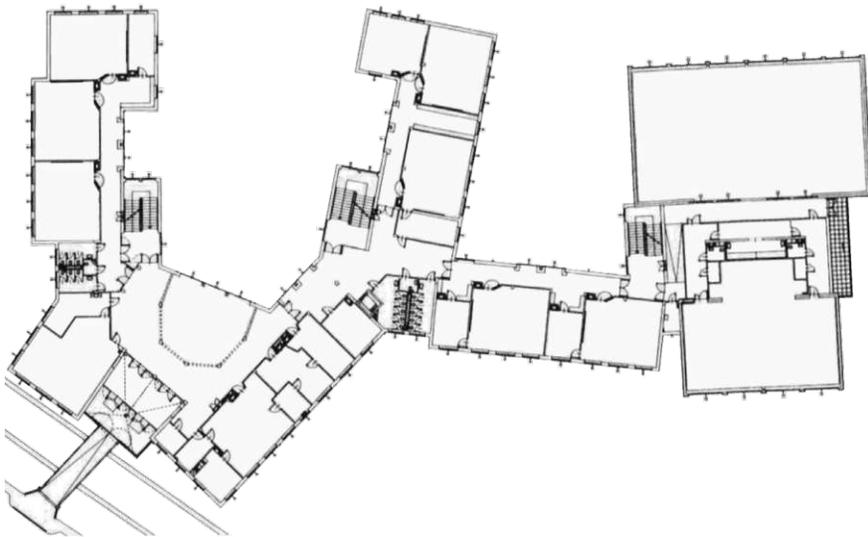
Grundriss 1.OG, Rosa Jochmann-Schule
